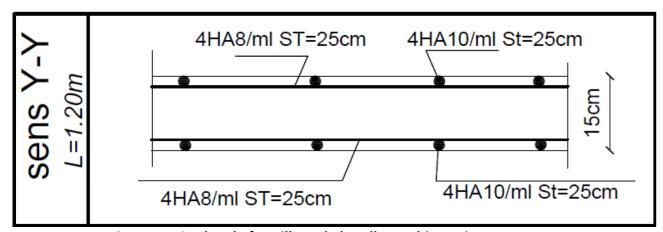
plan de ferraillage de la salle machine suivant y-y
